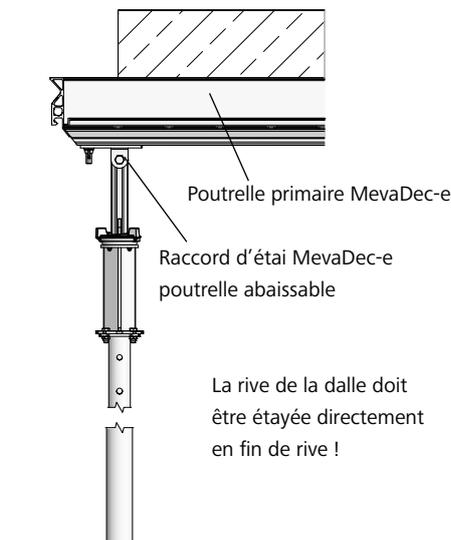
Méthode à poutrelles primaires et panneaux en rive de dalle
